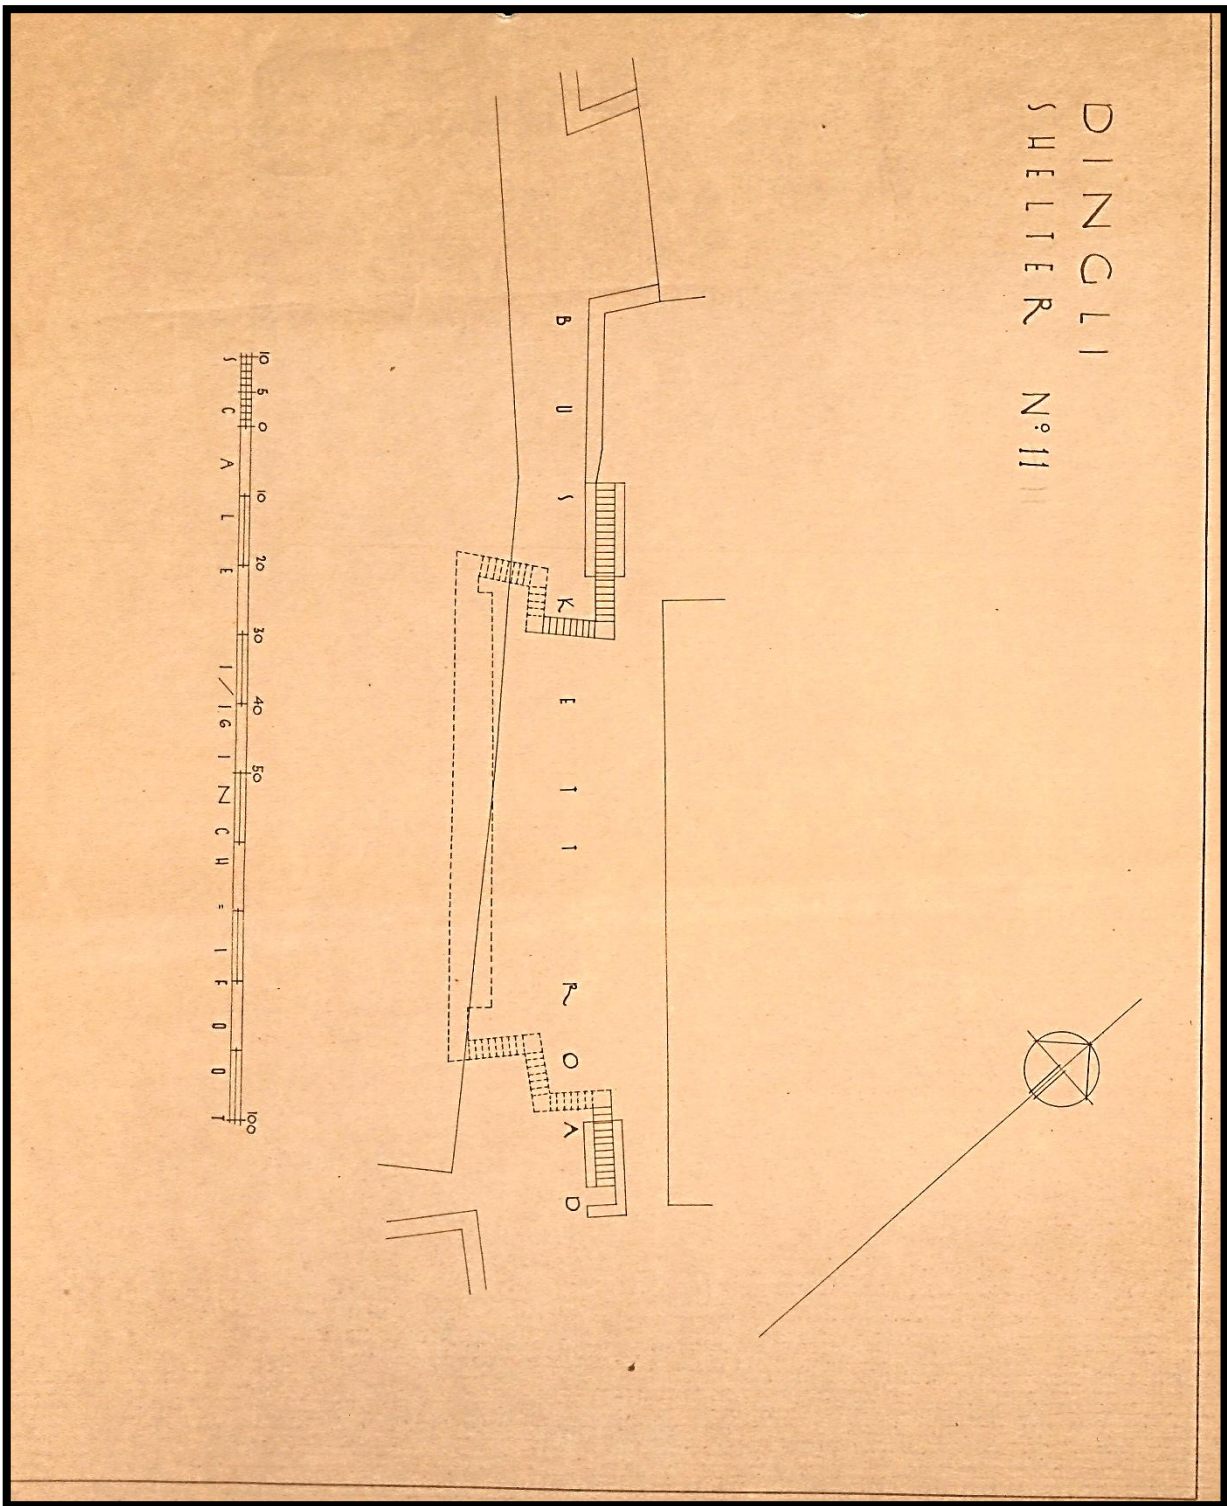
Planta do Abrigo nº 11 "Buskett Road"
